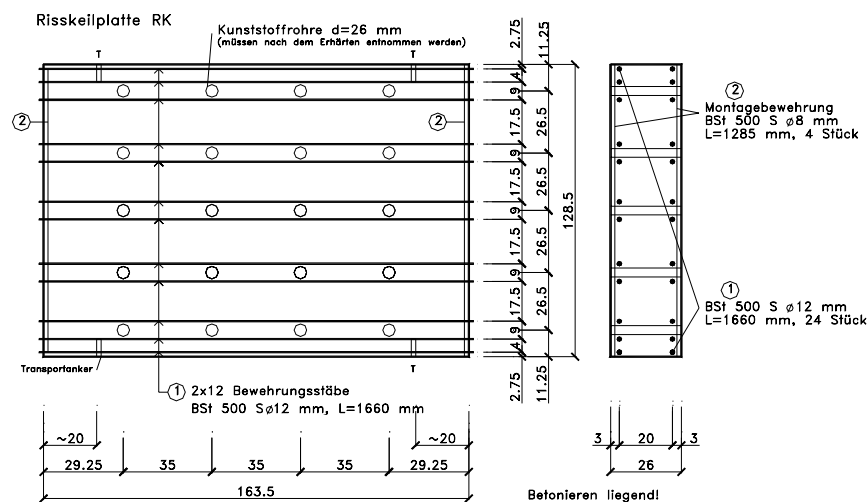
Zeichnung einer typischen Betonplatte für Versuche im gerissenen Beton; Rissöffnung mit Keilen.
